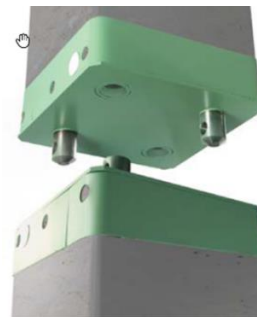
Junta rápida para pilote prefabricado según norma EN 12794
